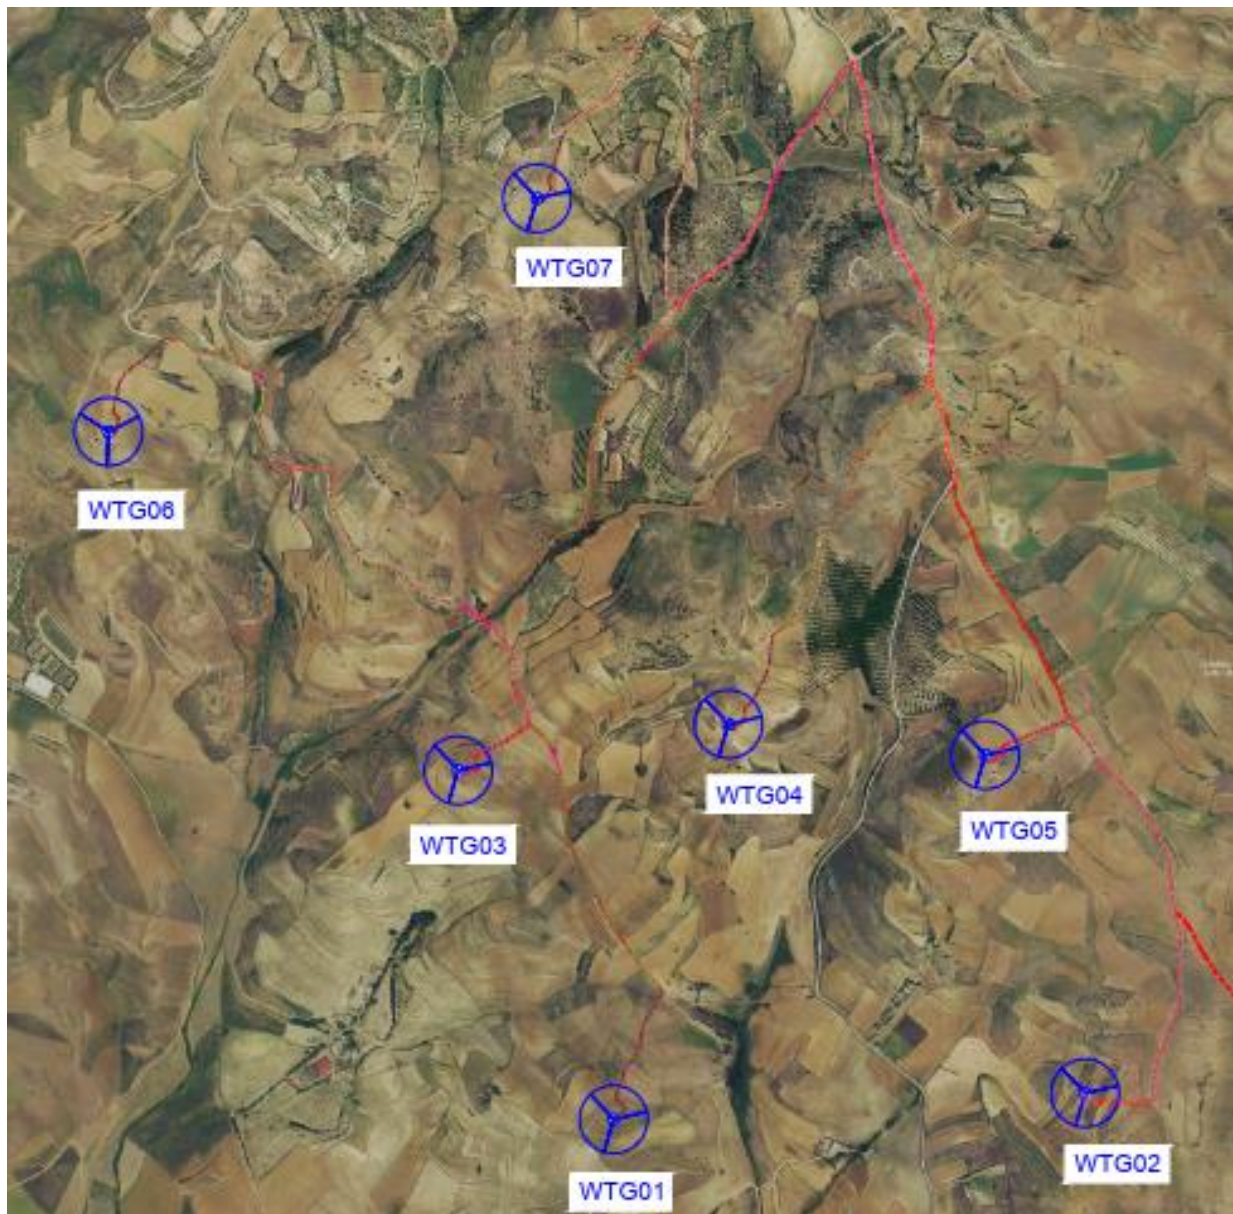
Layout della rete MT su ortofoto - impianto eolico
